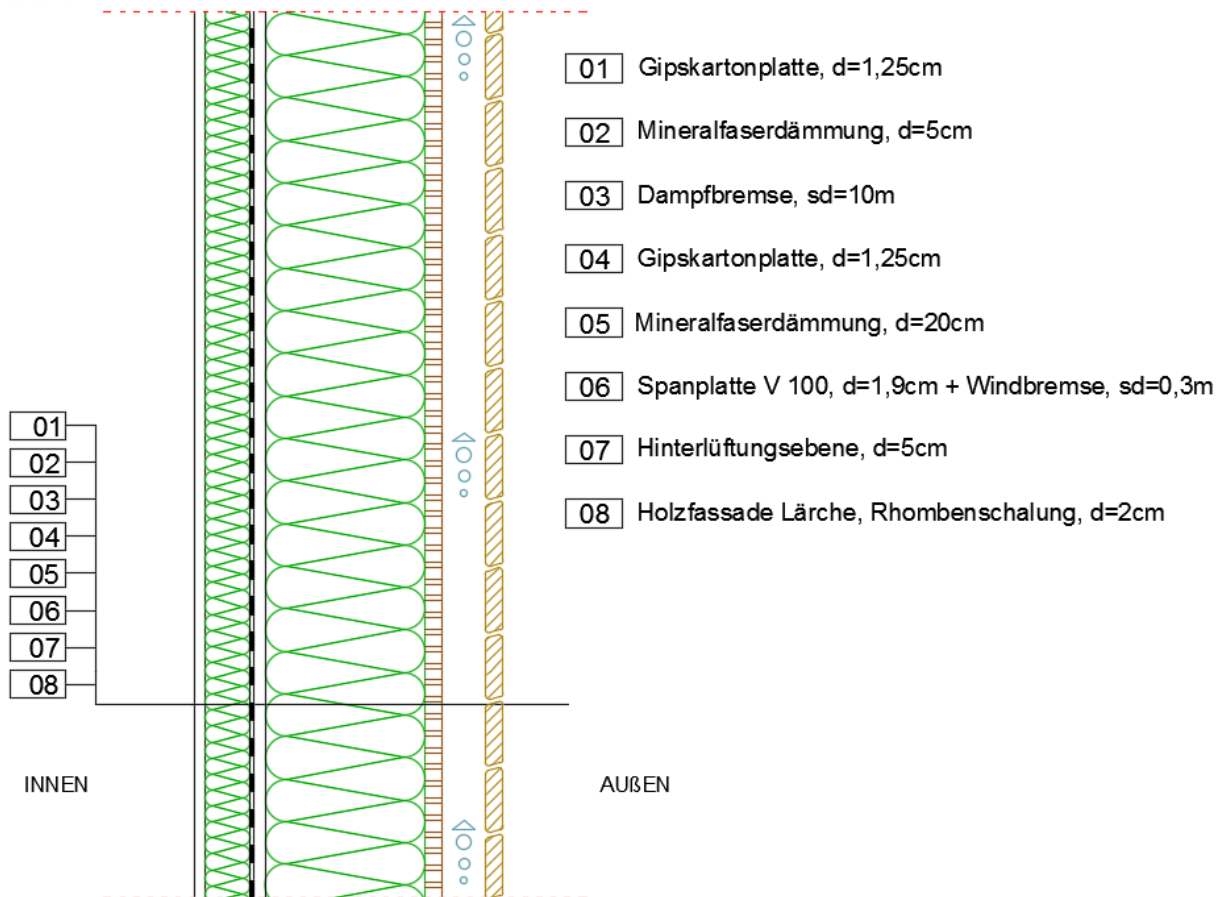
Holzriegelaußenwand, mit Hinterlüftung und mit gedämmter Installationsebene
